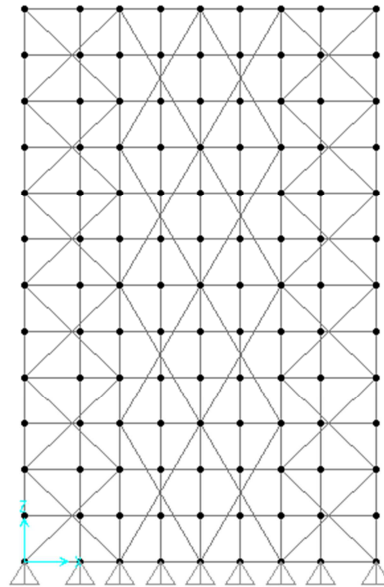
Configuração dos Planos de Contraventamento Vertical Com Elementos de Contraventamento Grandes
